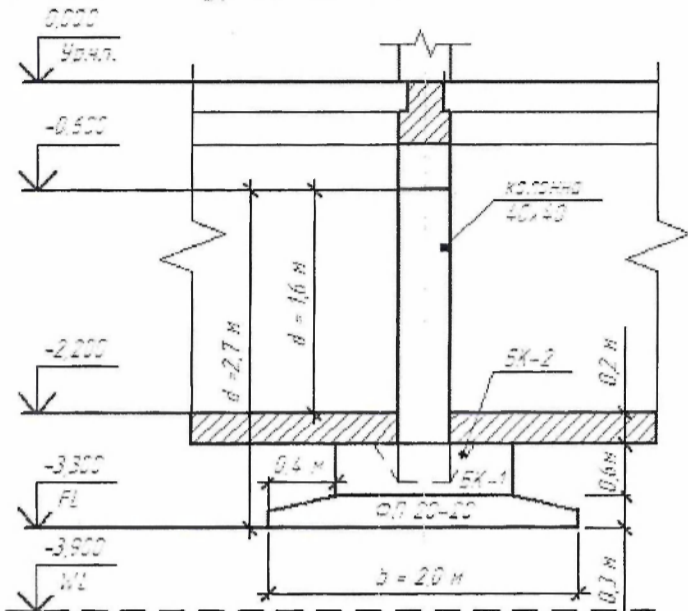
Изображения конструкций фундаментов. Фрагмент фундамента под колонну.
